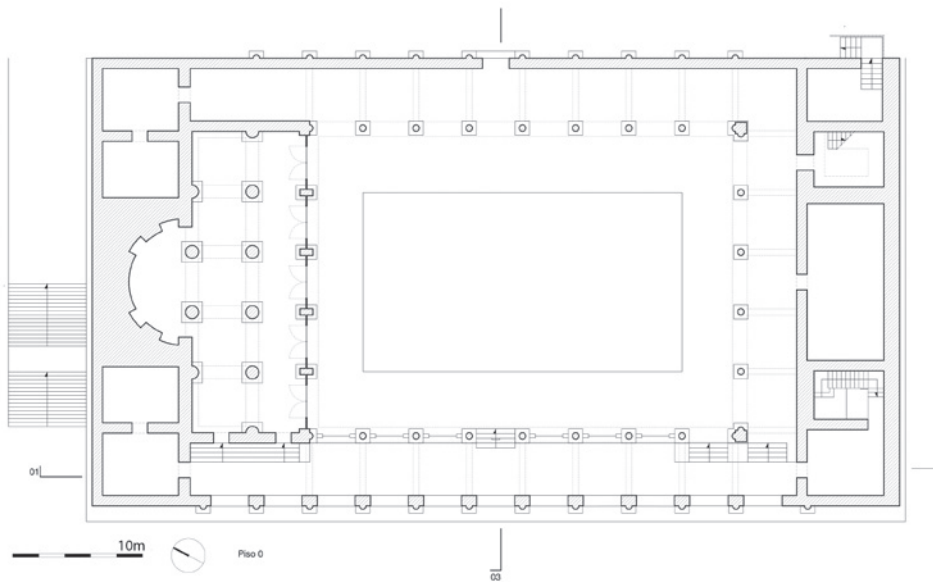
Planta do fórum claudiano. (Desenho de Paulo Barrelas).
